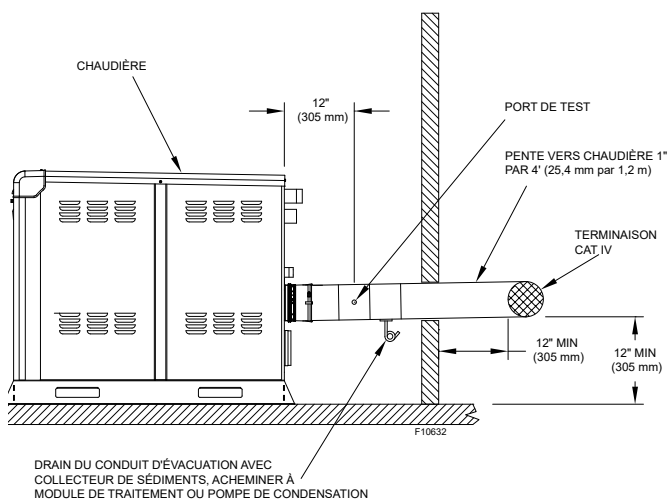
PVC/CPVC - Ventilation murale et horizontale
